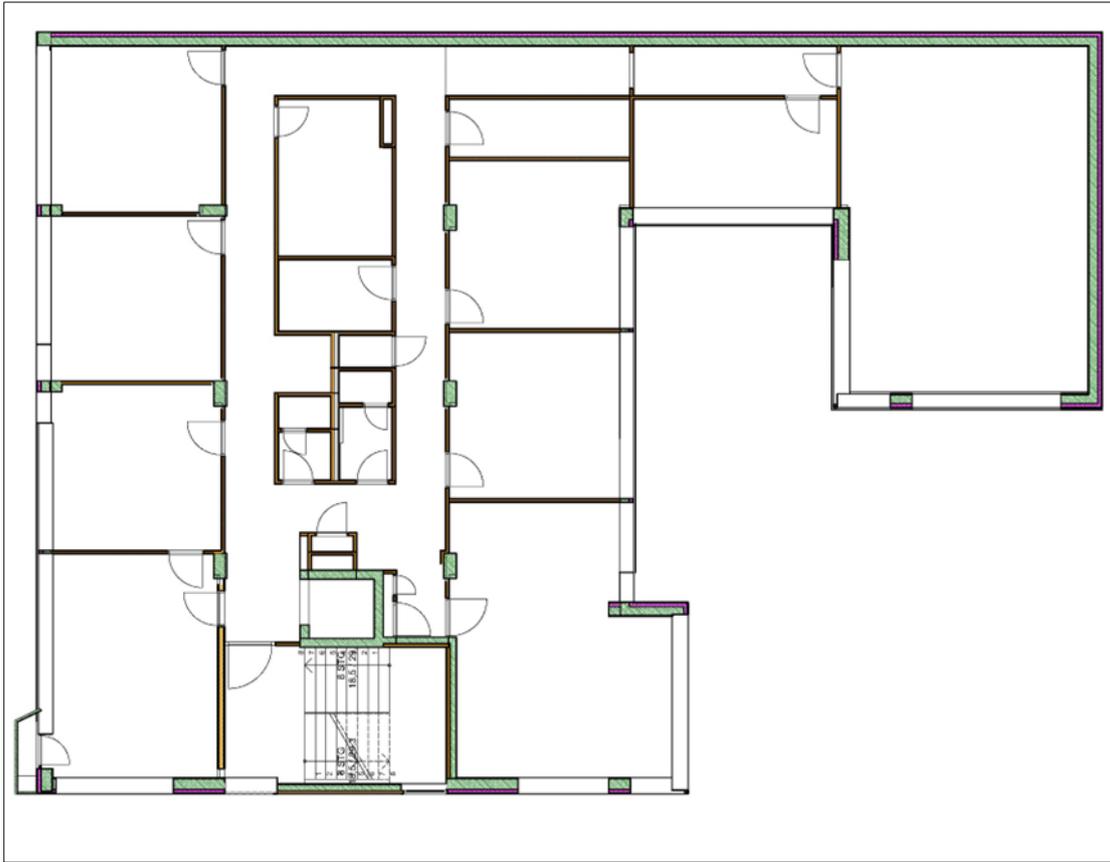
Fallbeispiel Grundriss OG1
